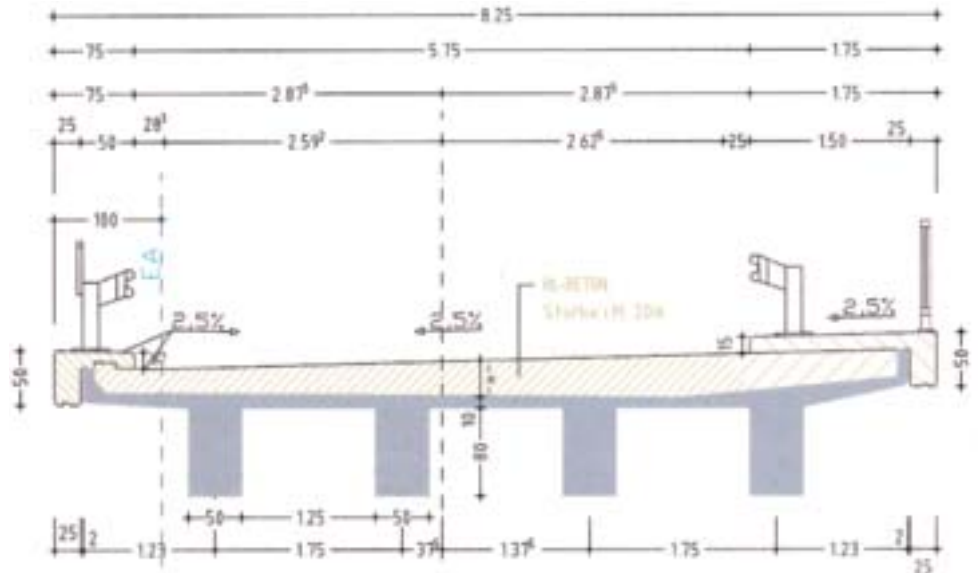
Weißbachbrücke STW 17 m, Fertigteile und Aufbeton mit Hochleistungsbeton
